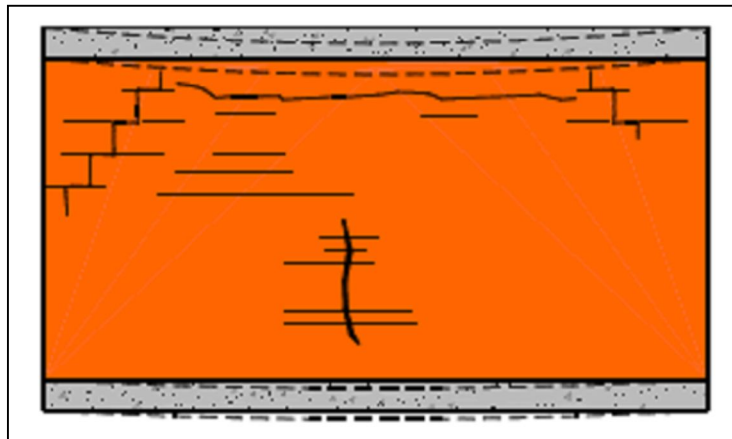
Fissuras em parede de compartimentação: Deformação do suporte inferior à deformação da viga superior. [37]
